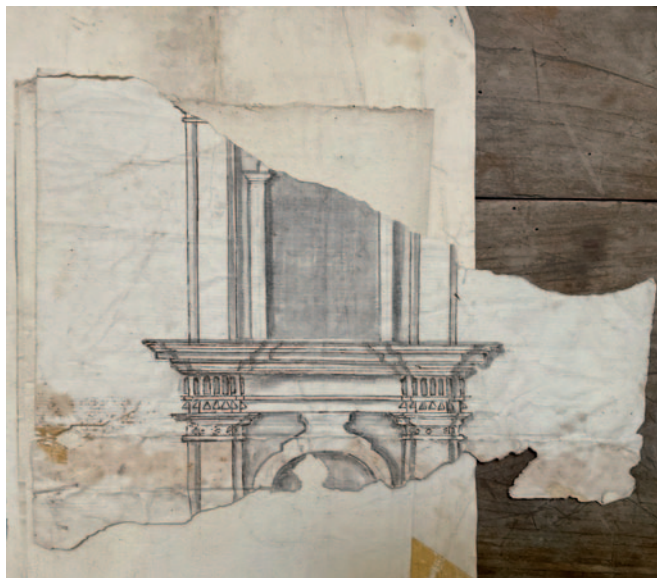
Progetto del campanile della chiesa Madre di Adrano, prospetto (Adrano, Archivio della Collegiata, carpetta Chiesa Madre. Campanile. Disegni).
